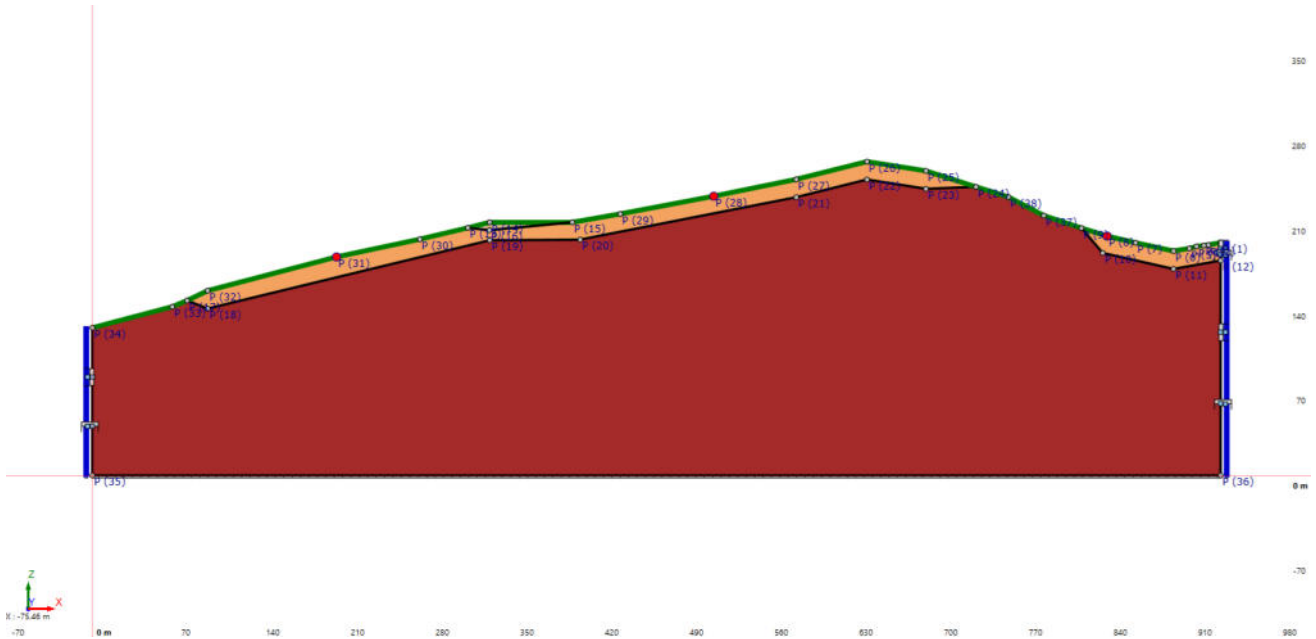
Sezione corrispondente alla manifestazione di interesse 166
